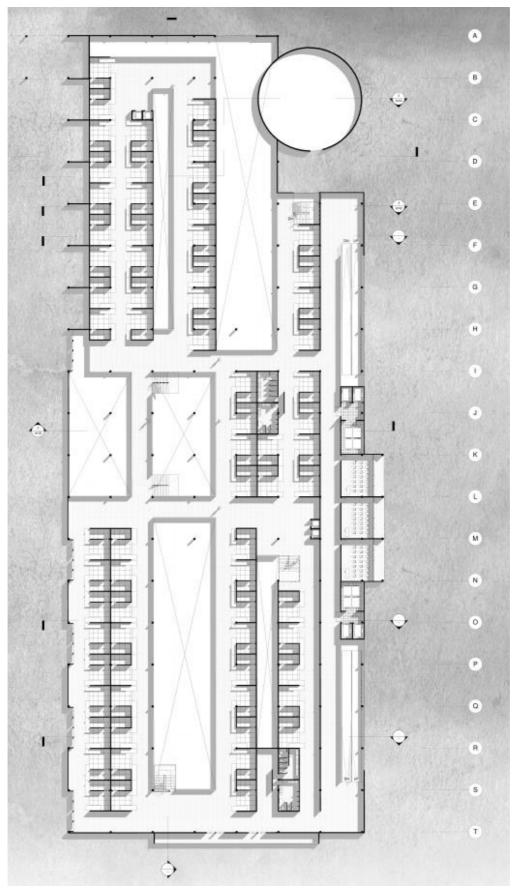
Planta alta 1 mercado Mayorista. Elaboración propia
